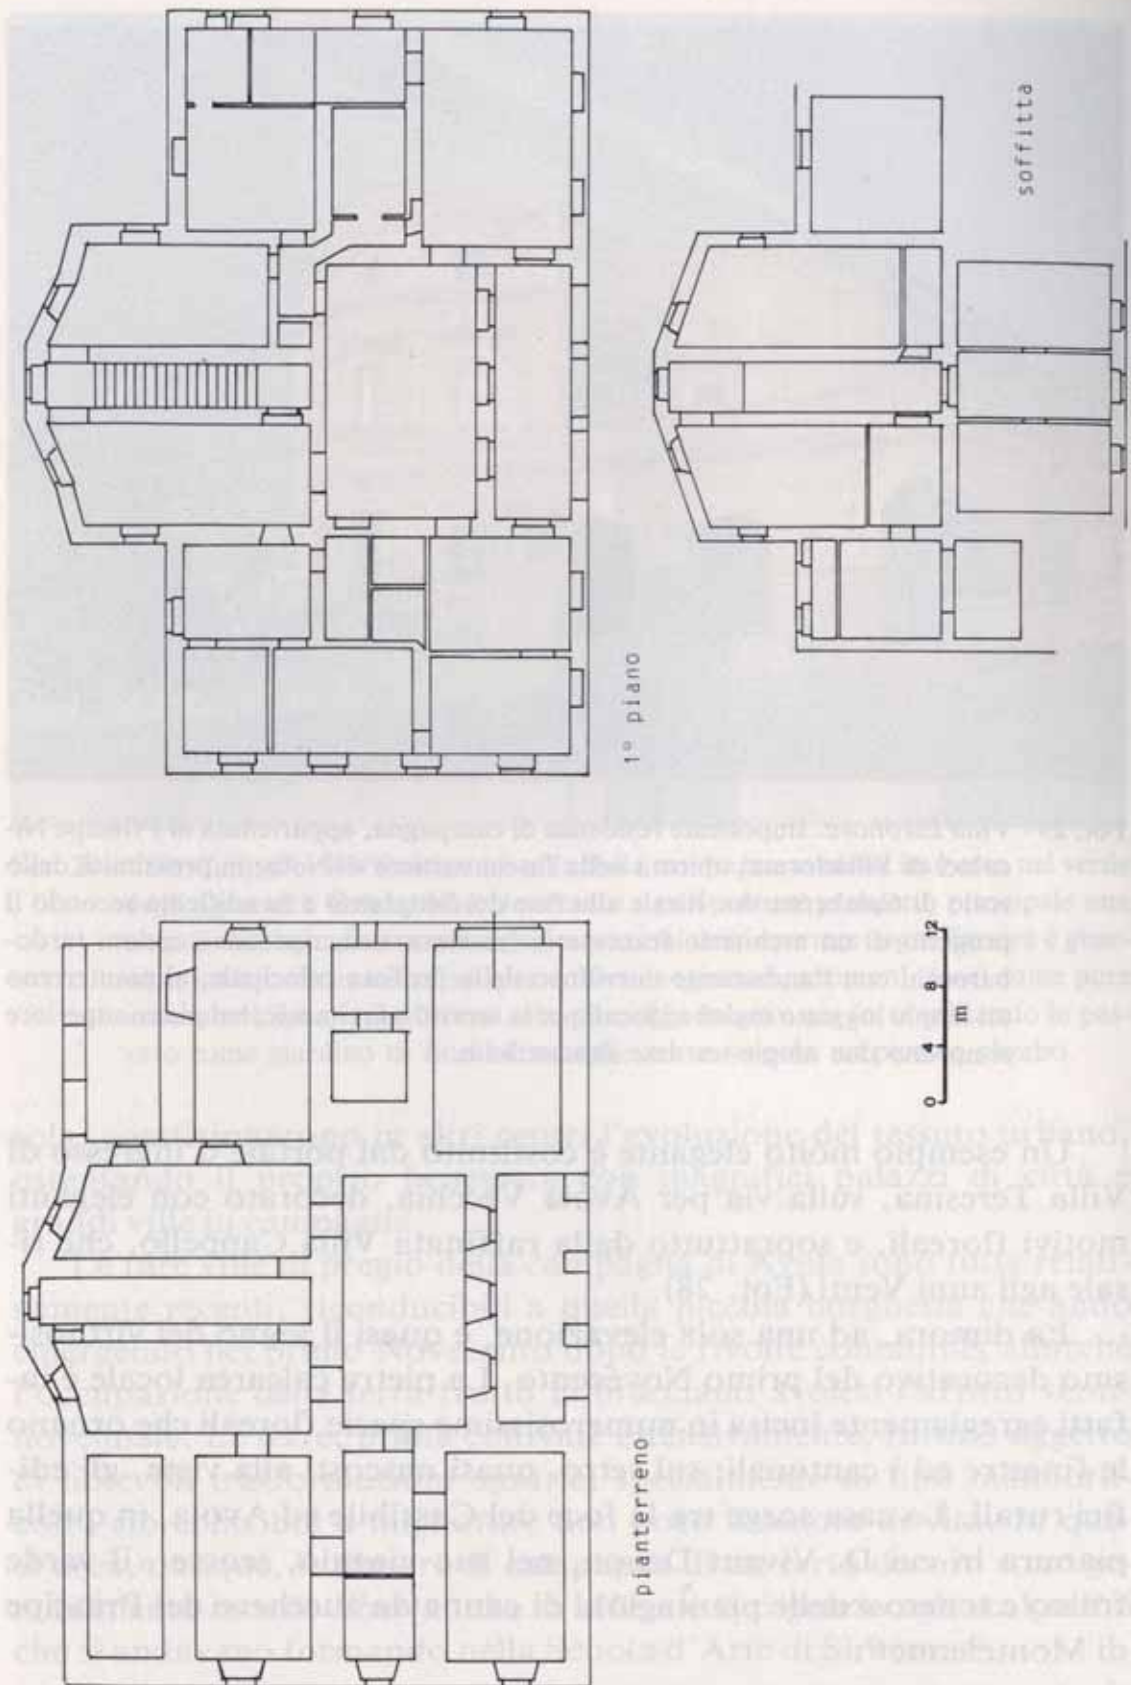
Villa Eleonora. Pianta del pianterreno, del primo piano e della soffitta.
